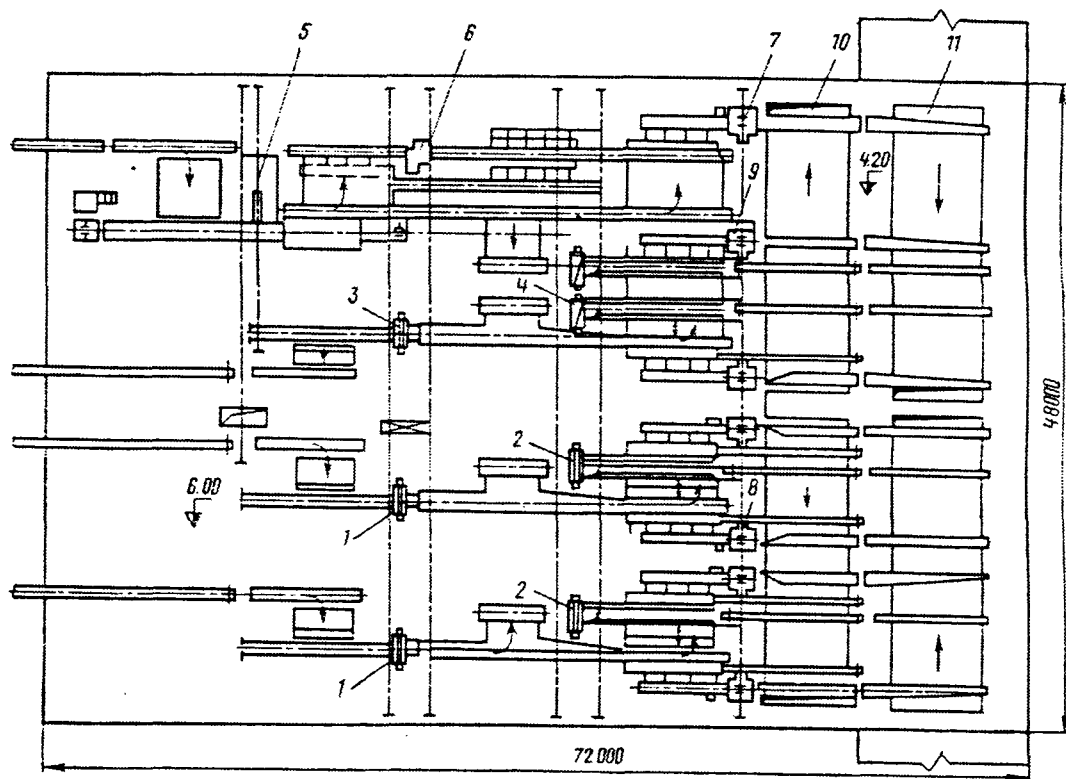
Схема двухпоточного лесопильного цеха (план 2-го этажа):
